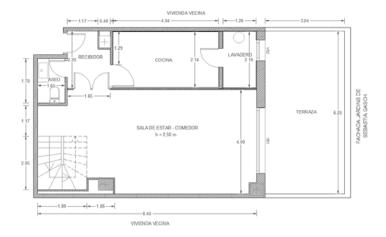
Plano estado actual Planta Baja. Fuente propia
